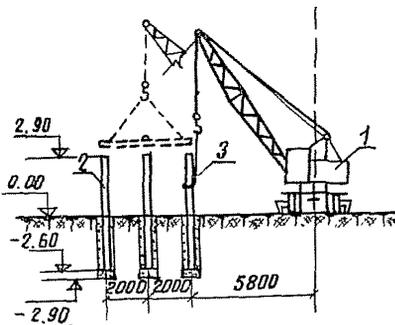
Разрез на стадии монтажа стоек и металлоконструкций опоры УО-110-105:
